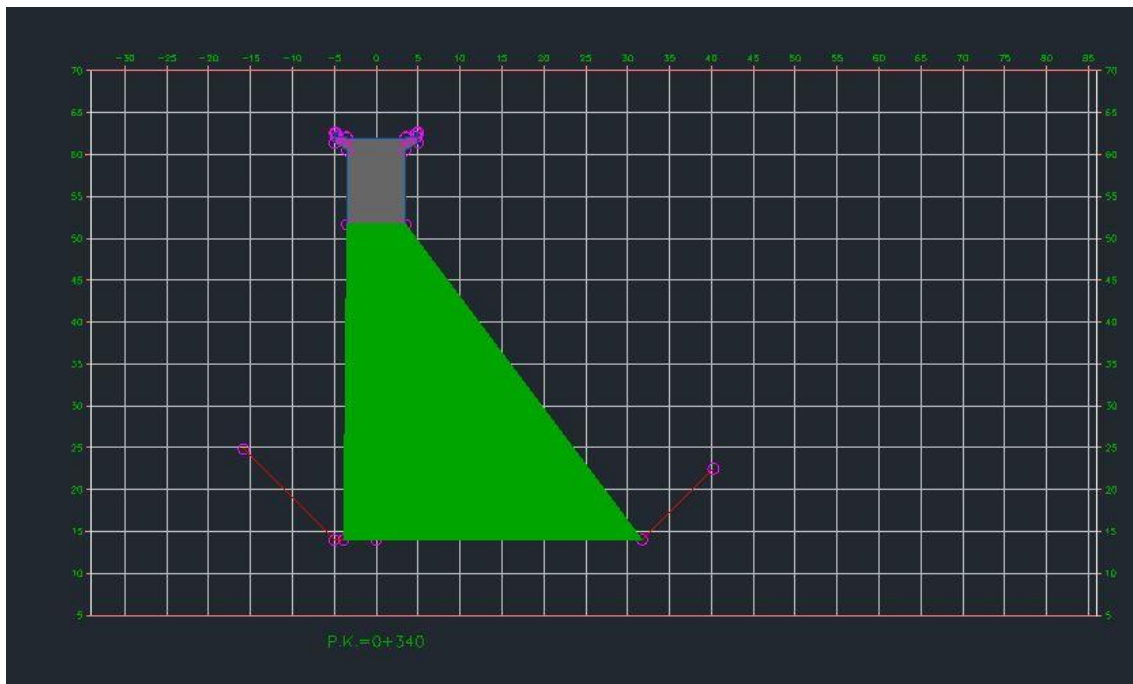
Sección transversal de la presa donde se delimita la cantidad de hormigón necesaria en la sección.
